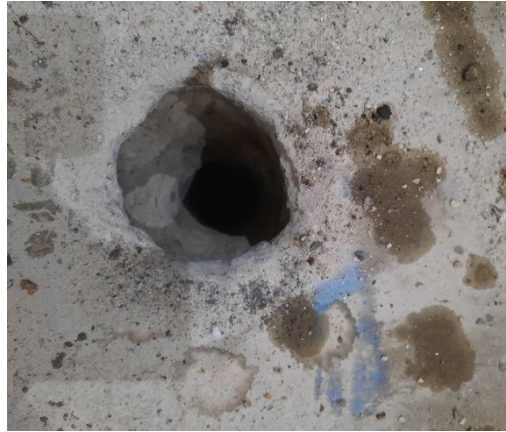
Furo de sondagem realizado no pavimento da refinaria
